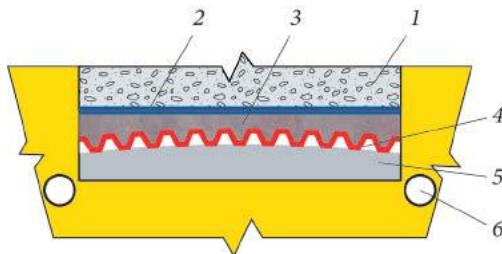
Устройство пластового дренажа с применением профилированной мембранны *PLANTER standard*: 1 — фундаментная плита; 2 — гидроизоляция; 3 — выравнивающая стяжка; 4 — профилированная мембрана *PLANTER standard*; 5 — бетонная подготовка с разуклонкой; 6 — дренажные трубы
